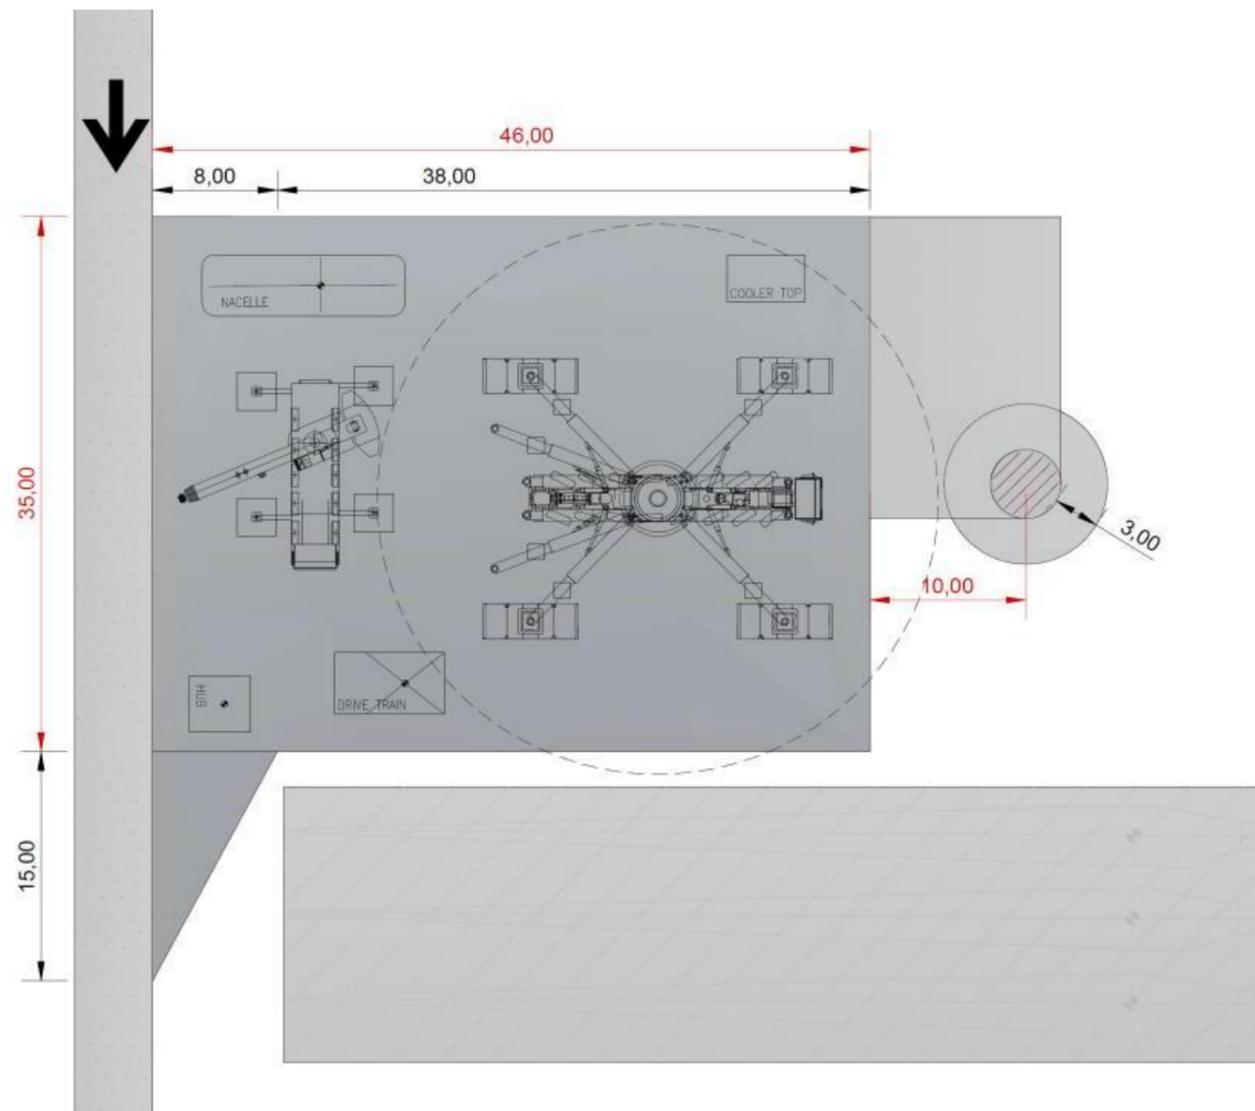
Exemple d'aire de montage (Source : VESTAS)
